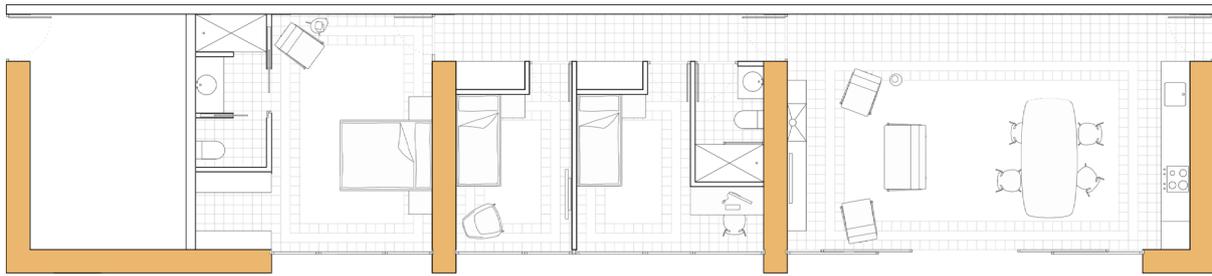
Plano de los muros portantes. 2018. Fuente propia.
